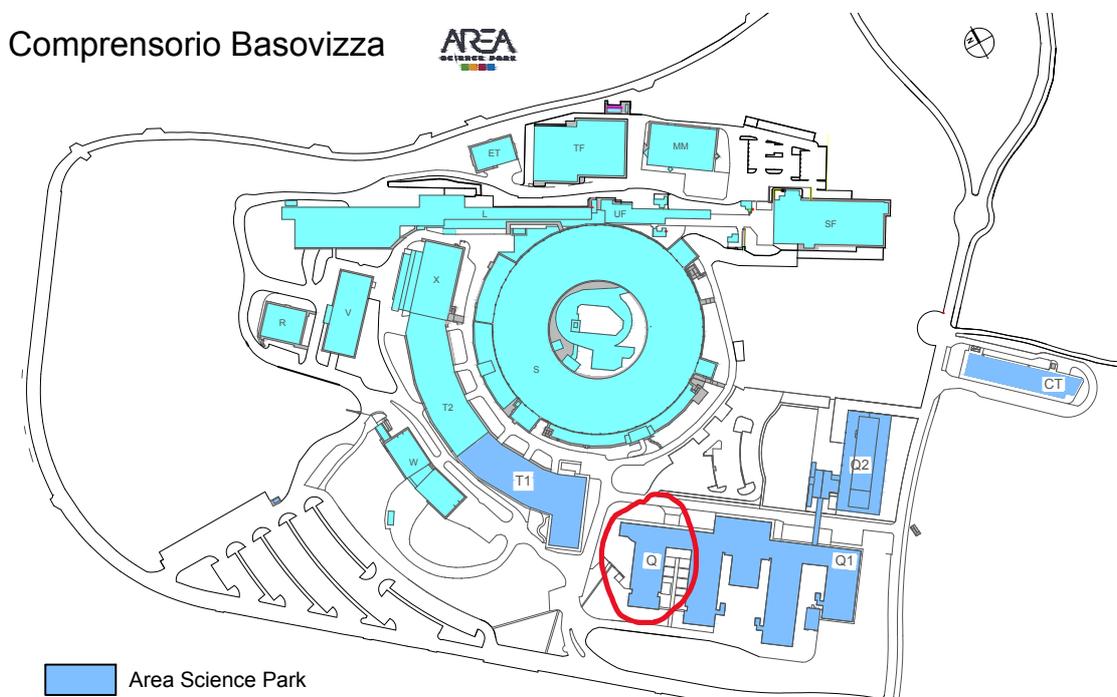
Vista aerea dell'area d'intervento. Edificio Q, Basovizza Trieste.
